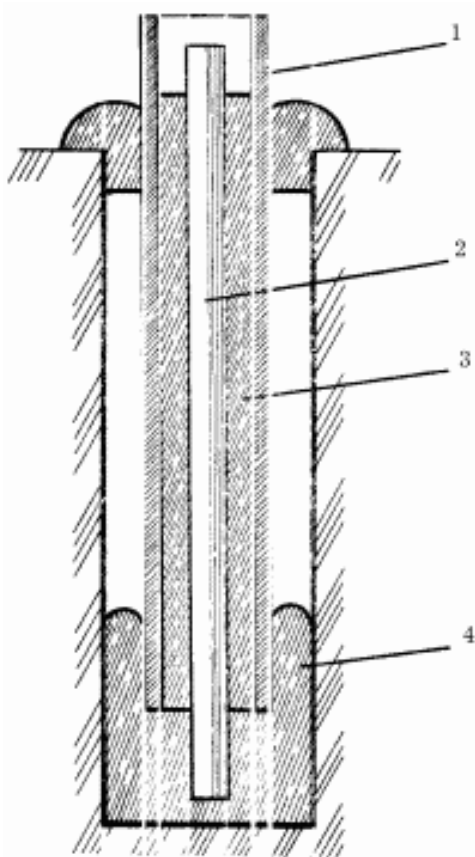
Буровая свая фундамента: 1 – асбестоцементная труба; 2 – арматура; 3 – бетон; 4 – буровая скважина.
